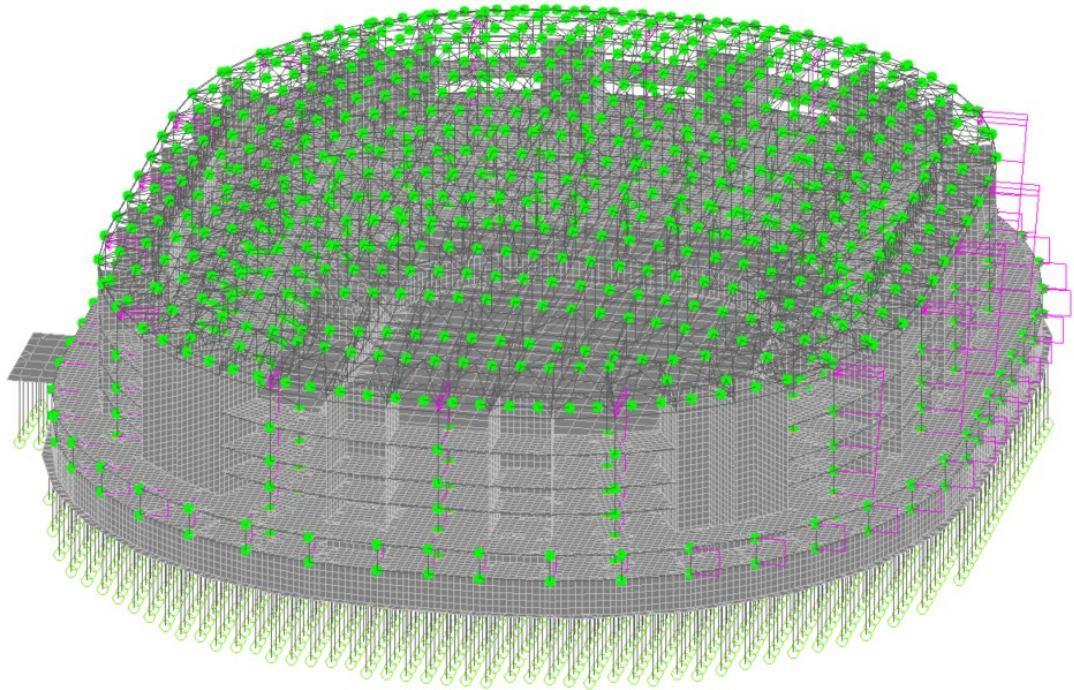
Схема приложения ветровой нагрузки на стены по оси Y
